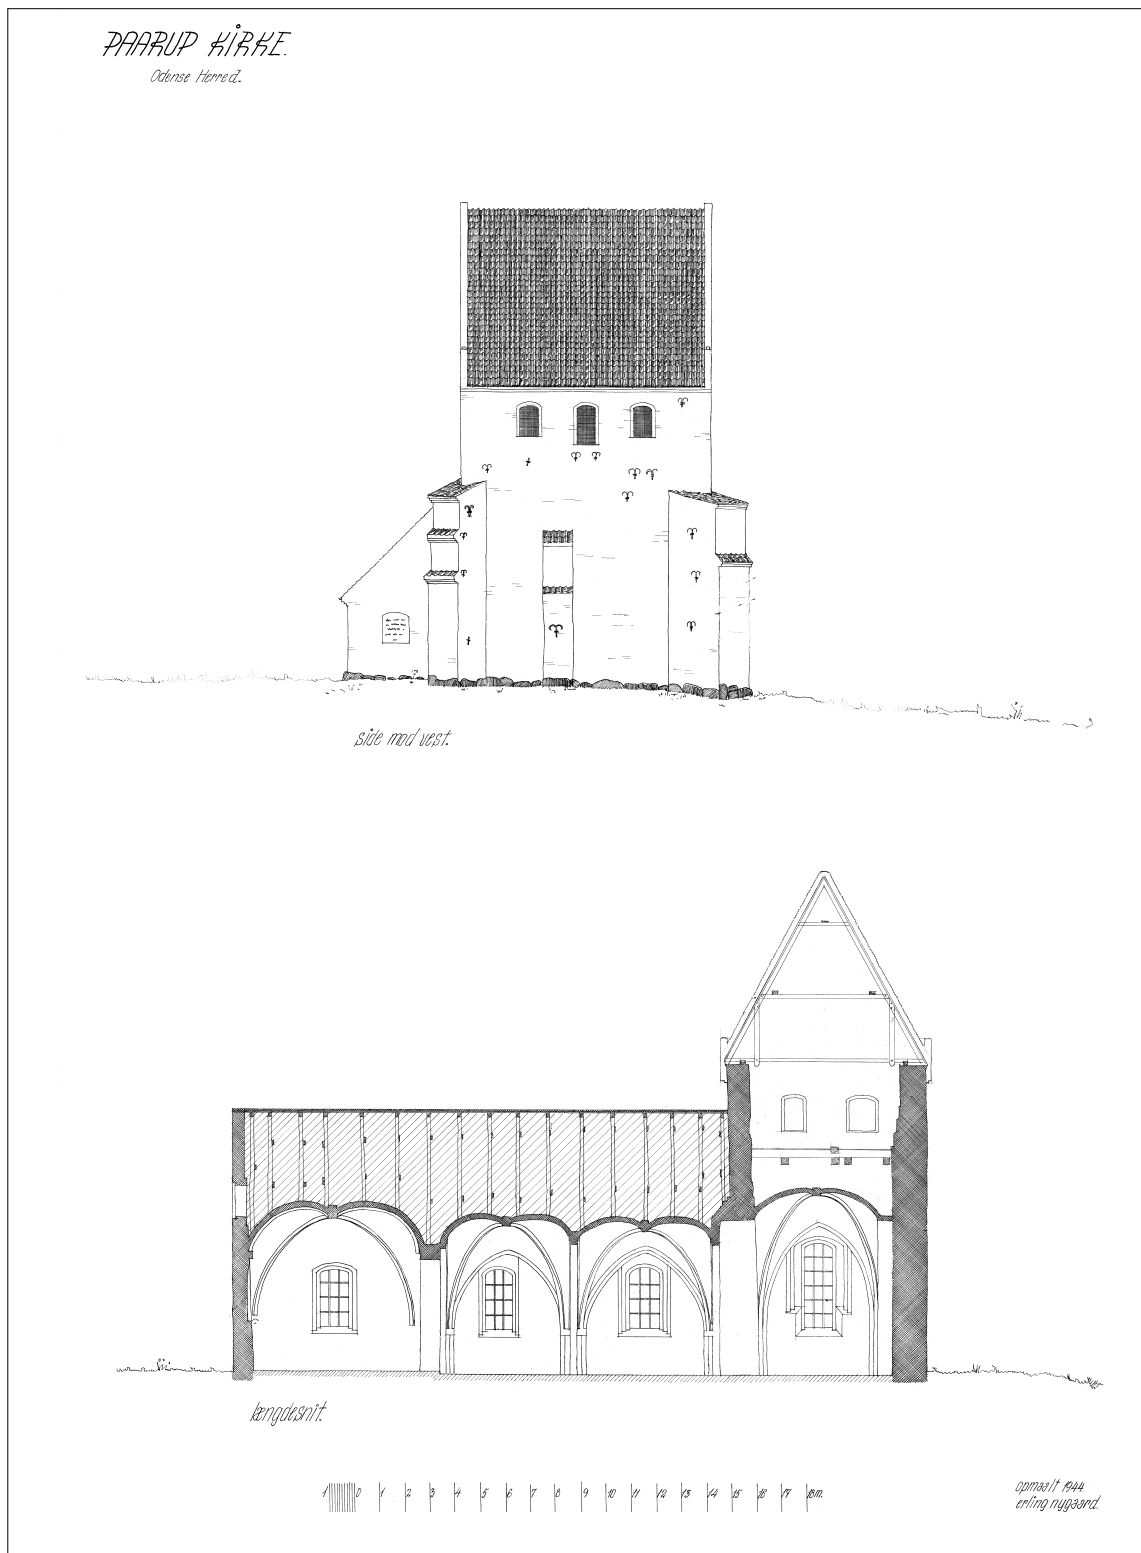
Opstalt og snit. 1:300. Målt og tegnet af Erling Nygaard 1944. – Elevation and longitudinal section.
